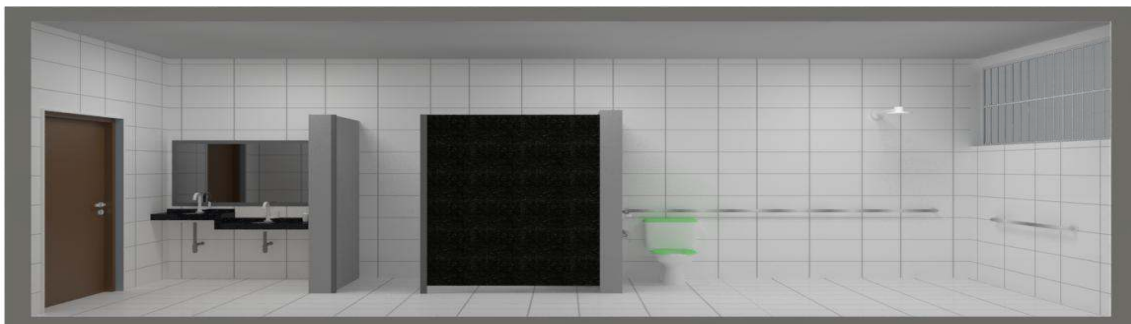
Vista 3D lateral da proposta para o Banheiro Tipo
